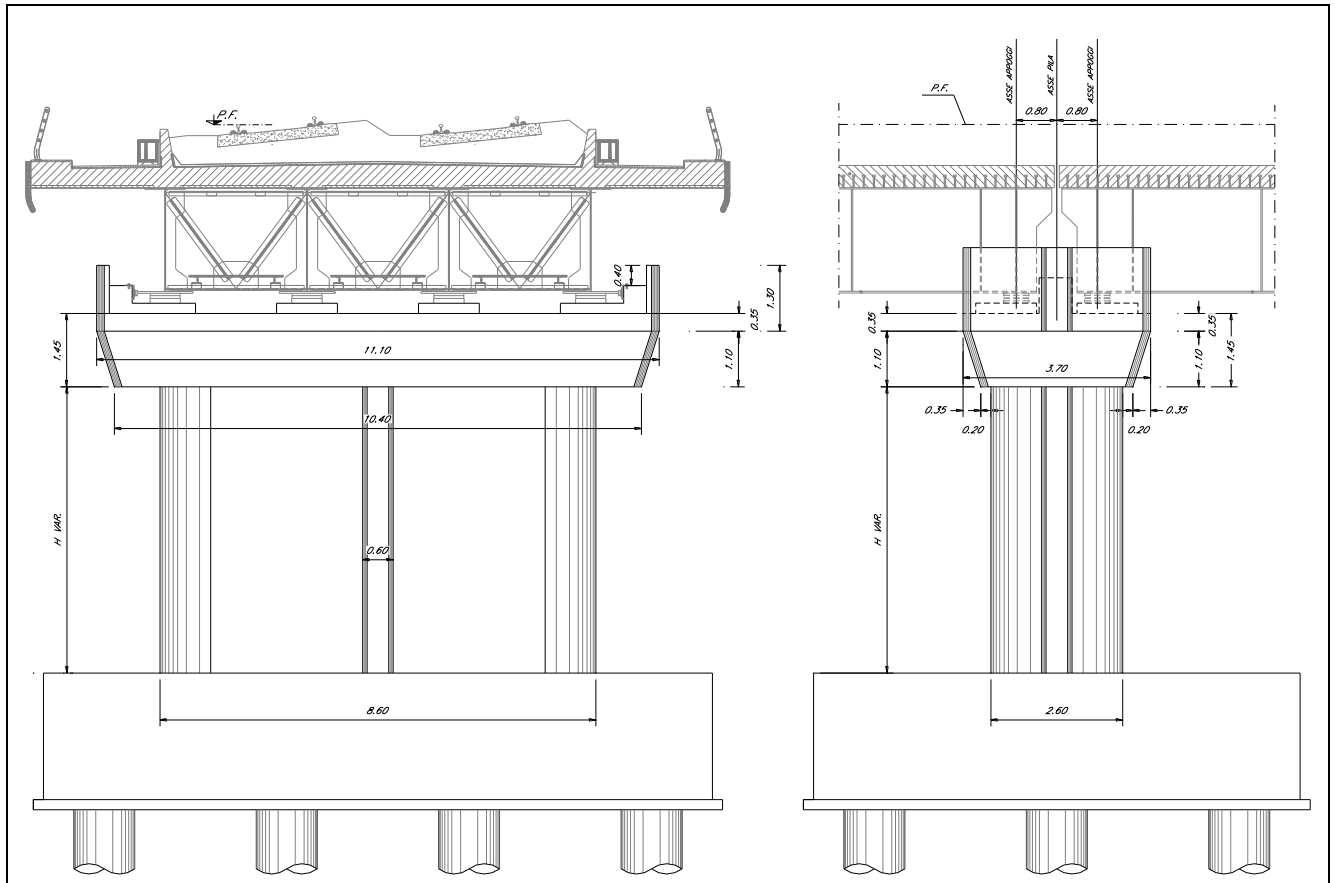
Viste pila tipologica per impalcato L=34.00m
